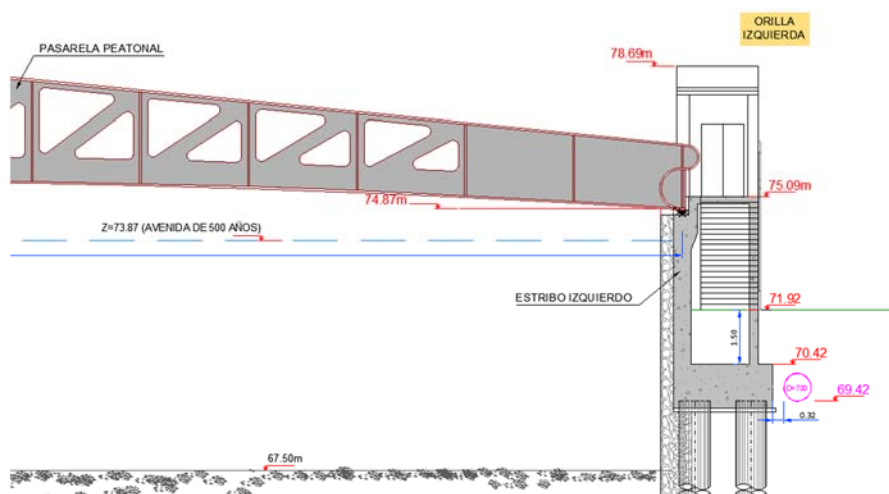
Detalle cimentación margen izquierda y tubería de abastecimiento
